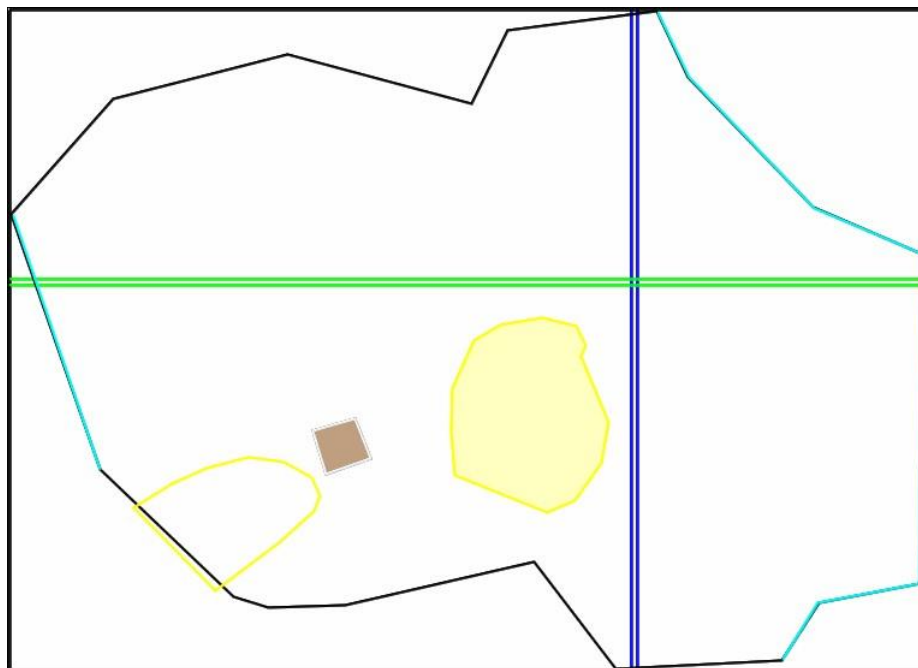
Vista em planta das secções de corte para a Fase 1
